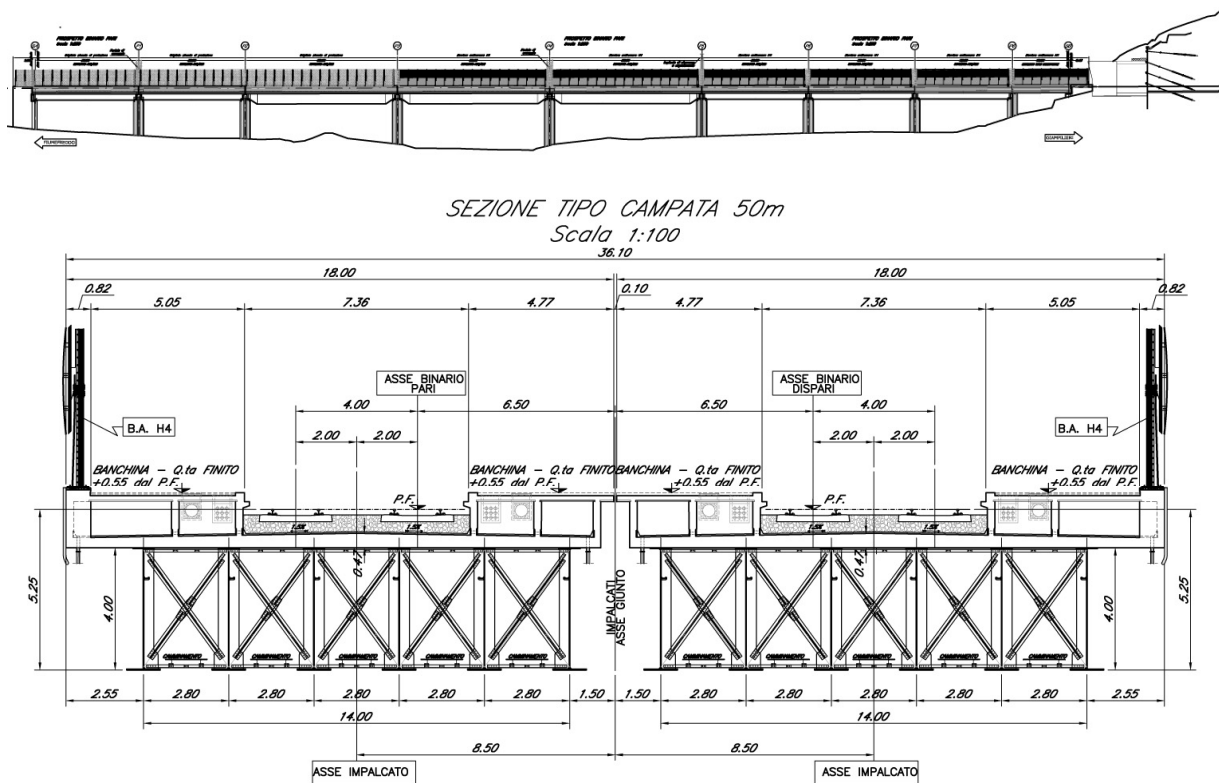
Viadotto fiumara d’Agrò: sezione trasversale e prospetto binario pari
